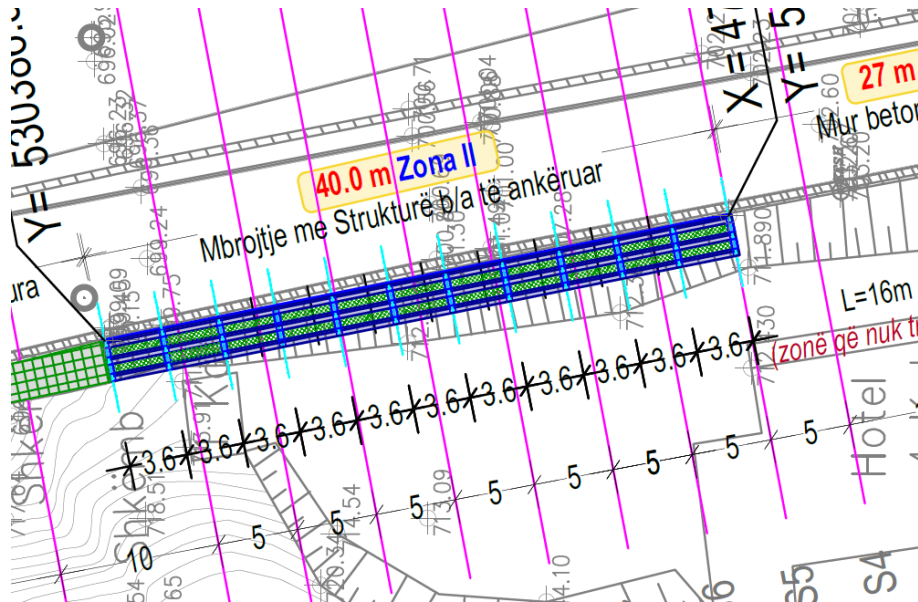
Pozicioni i strukturës betonarme dhe ankorave
